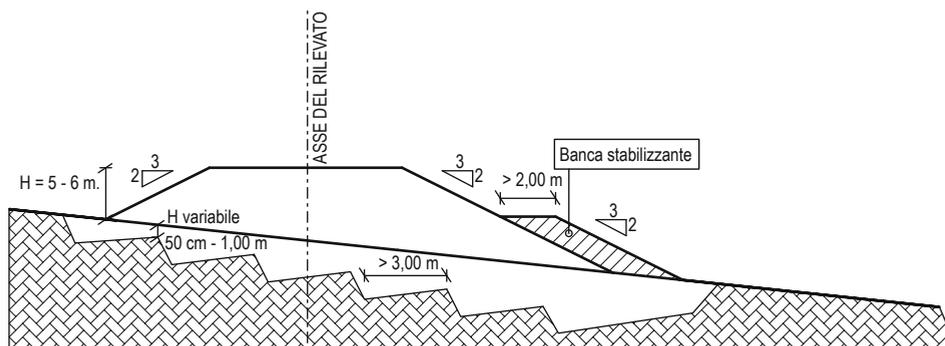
Rilevato su terreno a forte pendenza trasversale – Schema dell'intervento di gradonatura
